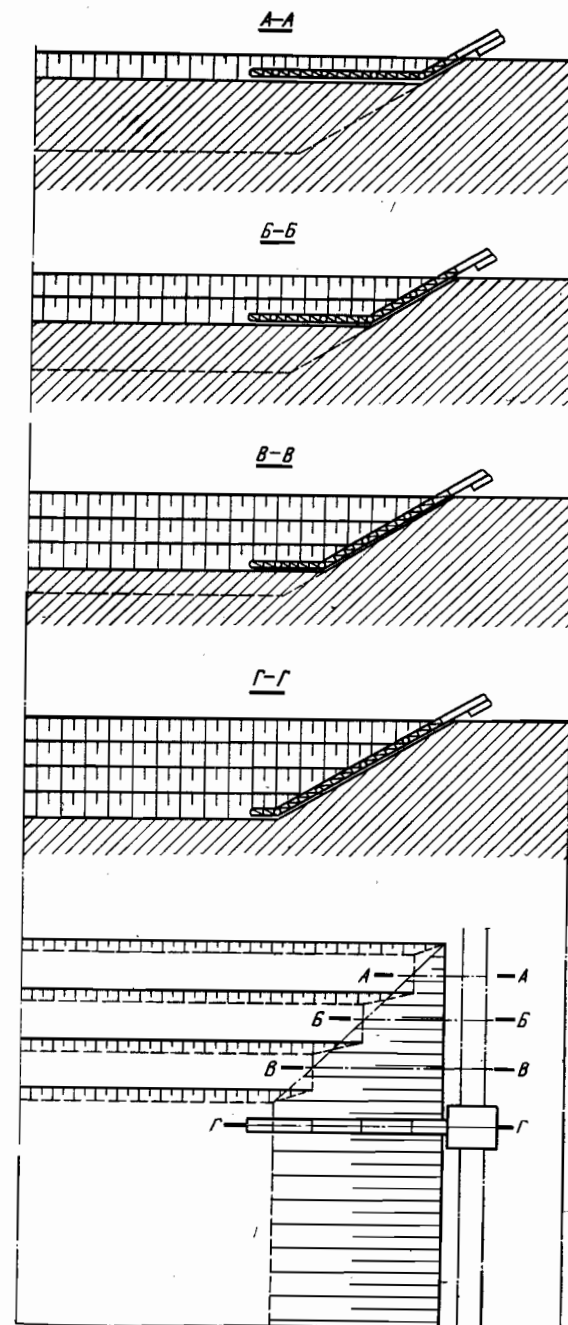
Схема отработки тупика неповоротным цепным экскаватором с четырехшарнирной ковшовой рамой
